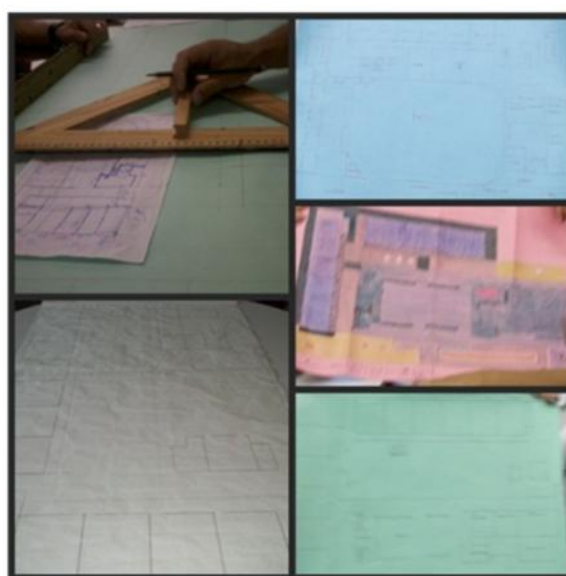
Apresentação das plantas baixas da escola São Sebastião.
